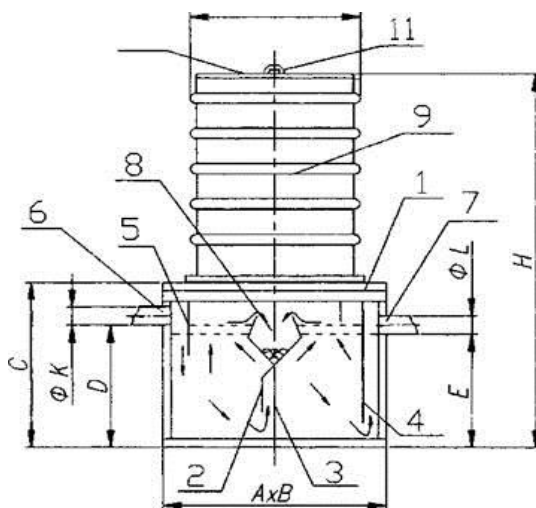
Чертеж конструкции жиросепаратора типа ОТБ: 1 - корпус жиросепаратора; 2-4 - погружная перегородка; 5 - полупогружная перегородка; 6 - подводящий патрубок с уплотнительным кольцом; 7 - отводящий патрубок с уплотнительным кольцом; 8 - пространство для накопления жира; 9 - надстройка; 10 - крышка с люком для обслуживания; 11 - ручка люка.
